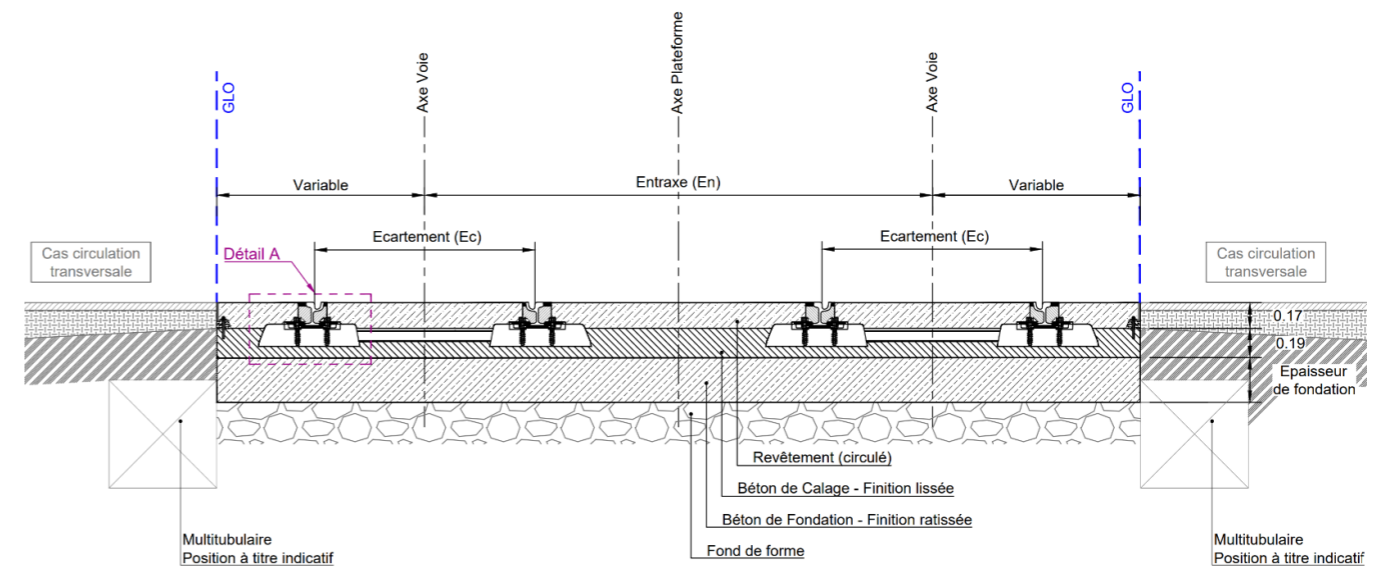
coupe type de plateforme – Voie béton traverses – Revêtement minéral circulé carrefour
